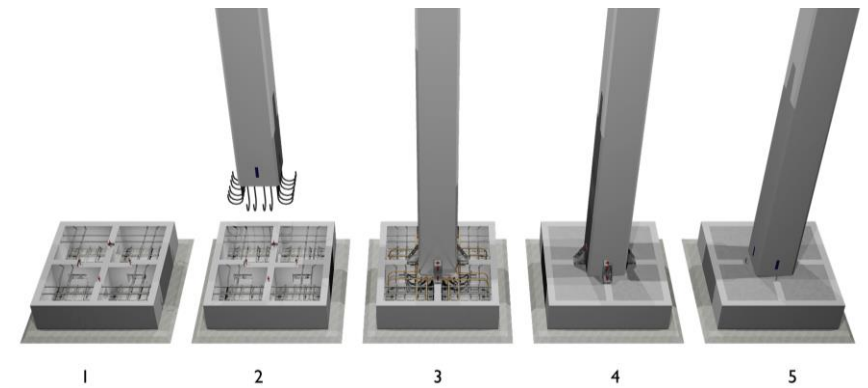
assemblage poteau- semelle isolée (source : monachinotechnology.com)
